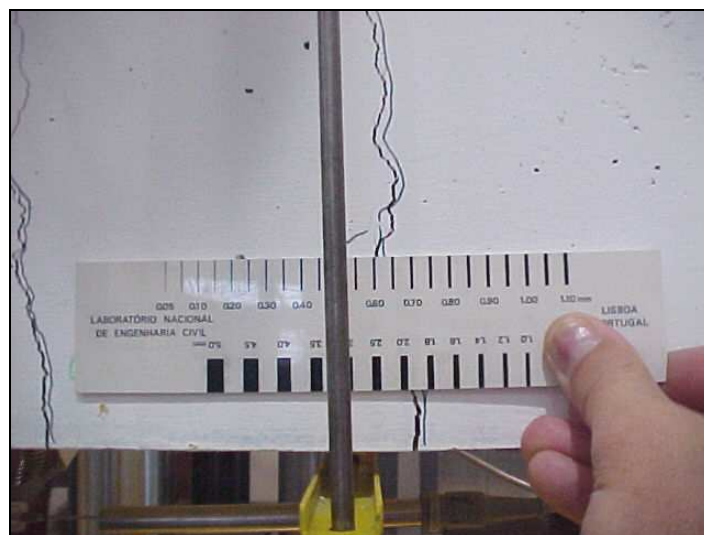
Pormenor da medição da abertura de fendas, ao nível da armadura, da viga A500_C35_d16.
